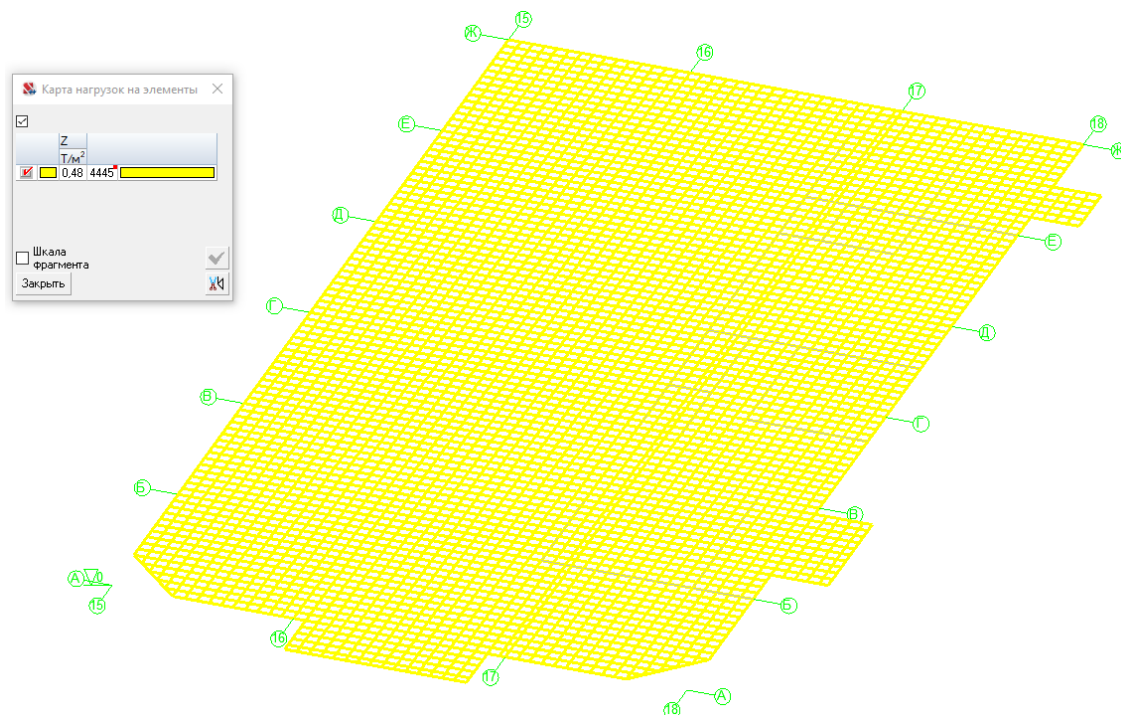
Загрузка плиты перекрытия полезной нагрузкой
